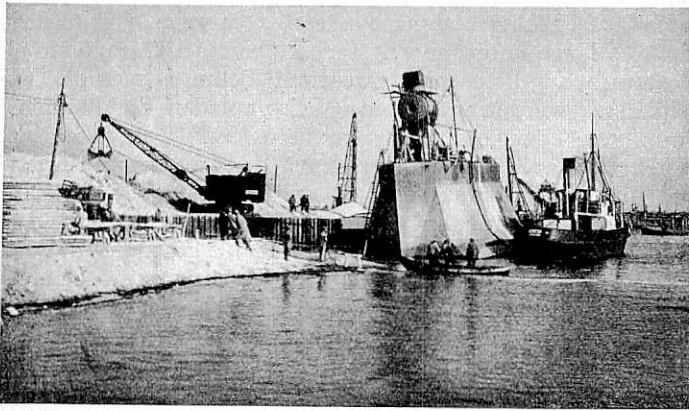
Bremspfeiler der Strelasundbrücke wird abgeschleppt zur Absenkstelle.
